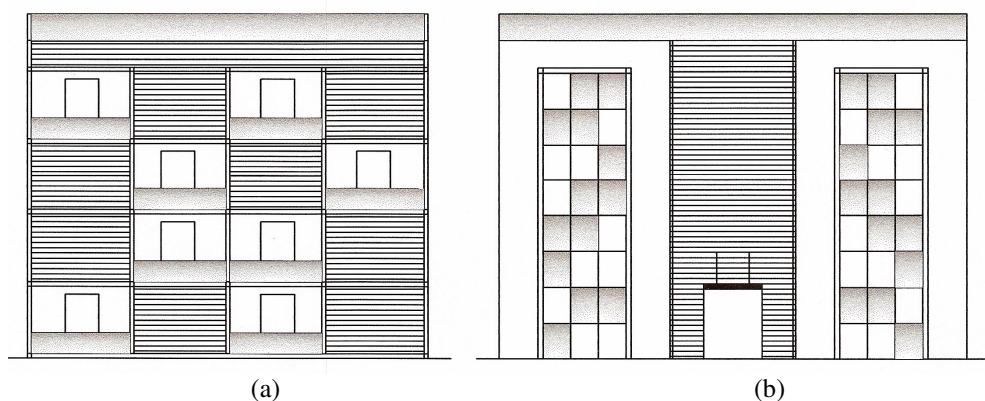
Propostas de fachadas – Opção A – (a) frontal (sacadas com posição distinta e brises móveis) e (b) lateral (painéis coloridos e fechamento metálico no acesso)
